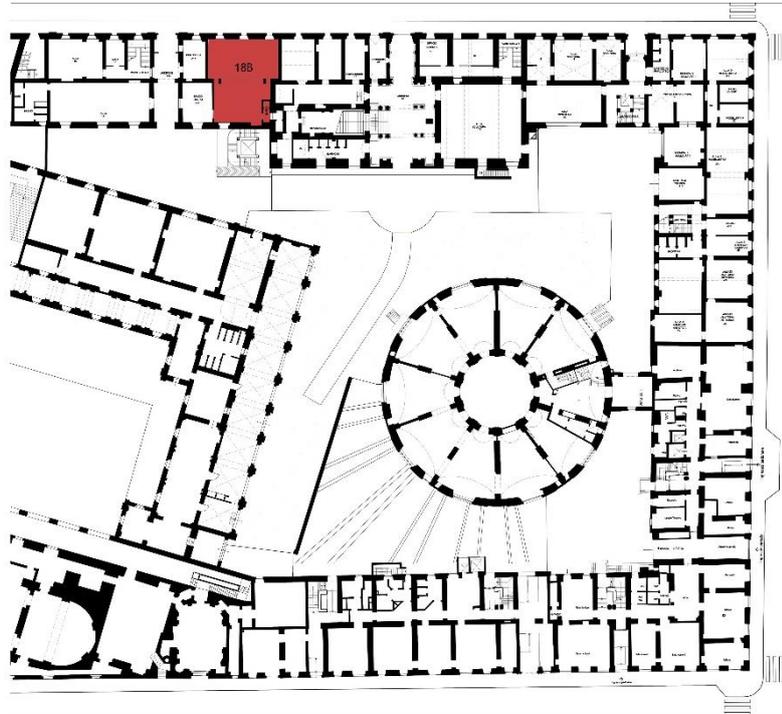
Pianta dello stato di fatto con indicazione dei locali riservati ai laboratori di Pittura, piano terra.
